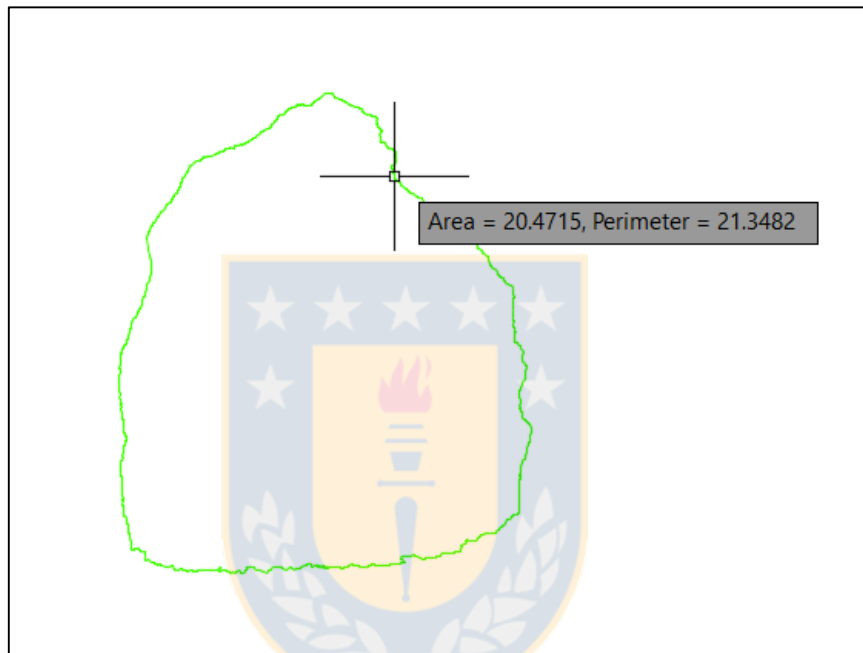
Vista frontal de sección transversal de área de máxima sobre-excavación.
